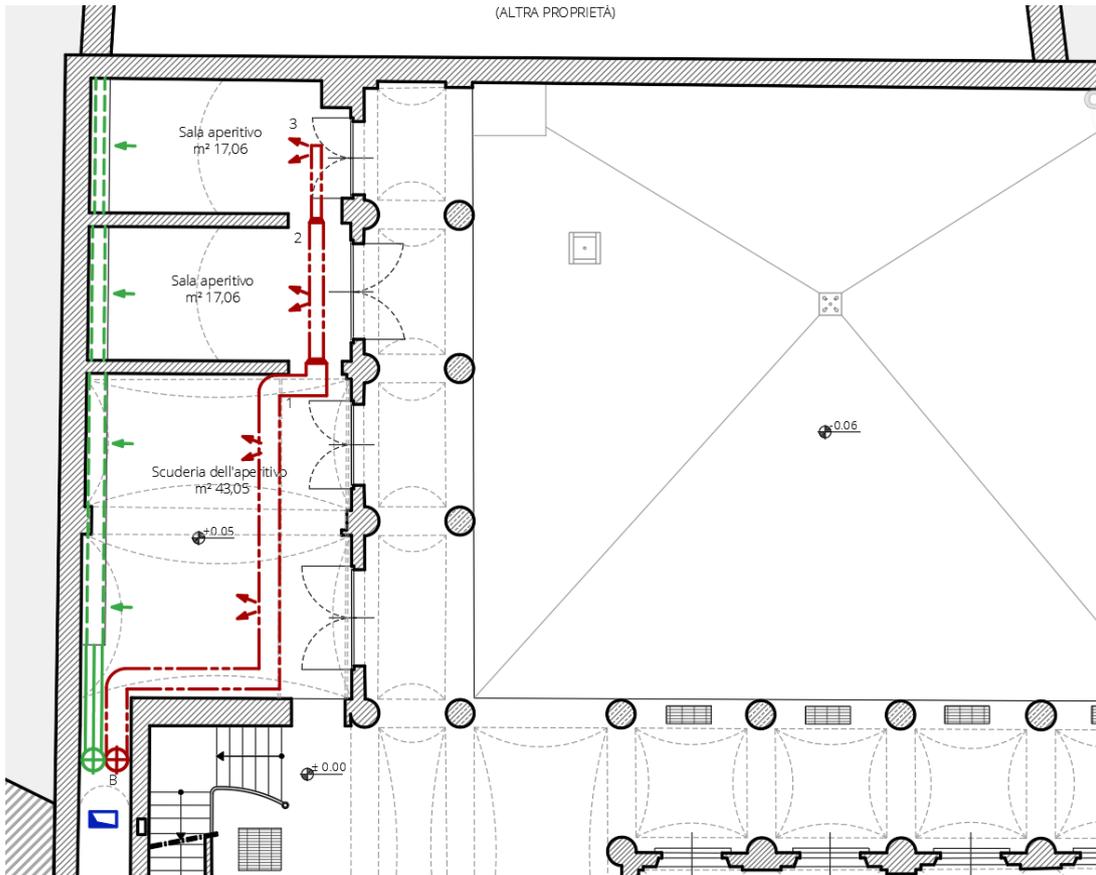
Estratto della pianta del piano terra che riporta il sistema di mandata e ripresa.
